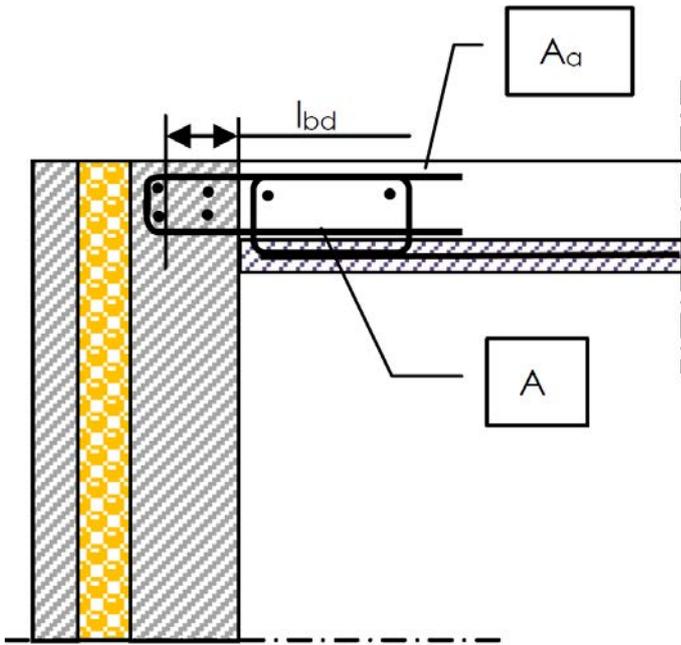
liaison avec plancher en béton à prédalle suspendue – hors zone sismique
